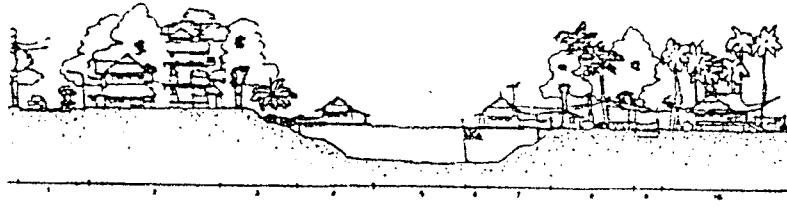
Lokasi Permukiman Raft House Sepanjang Sungai Sakaekrang di Prop.Uthaithani
